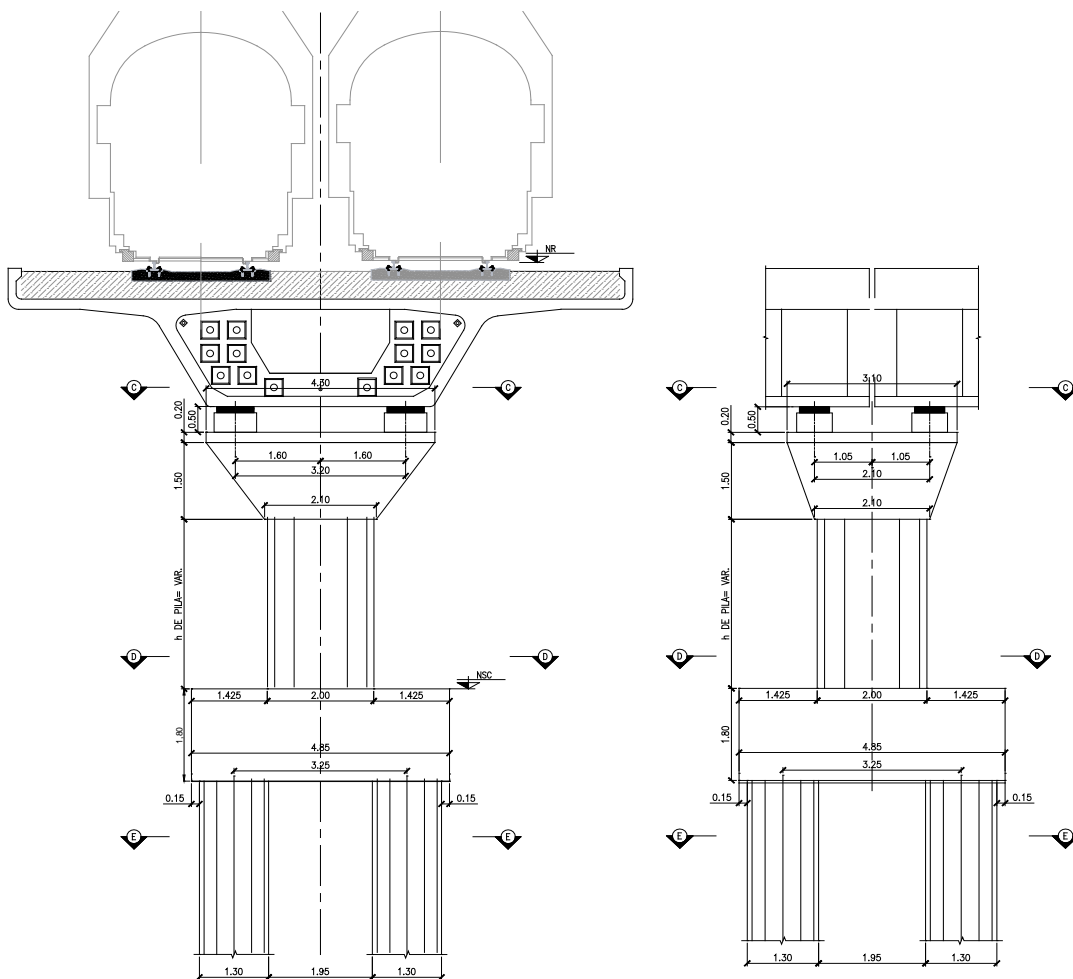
Esquemas de las pilas típicas de apoyo del viaducto.
